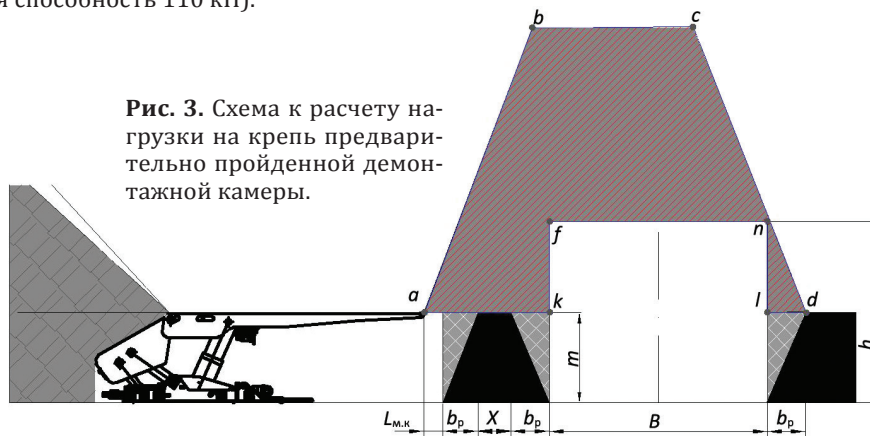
Схема к расчету нагрузки на крепь предварительно пройденной демонтажной камеры.
